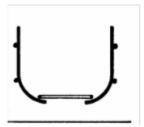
, Adherencia del Acero de Refuerzo al Concreto
